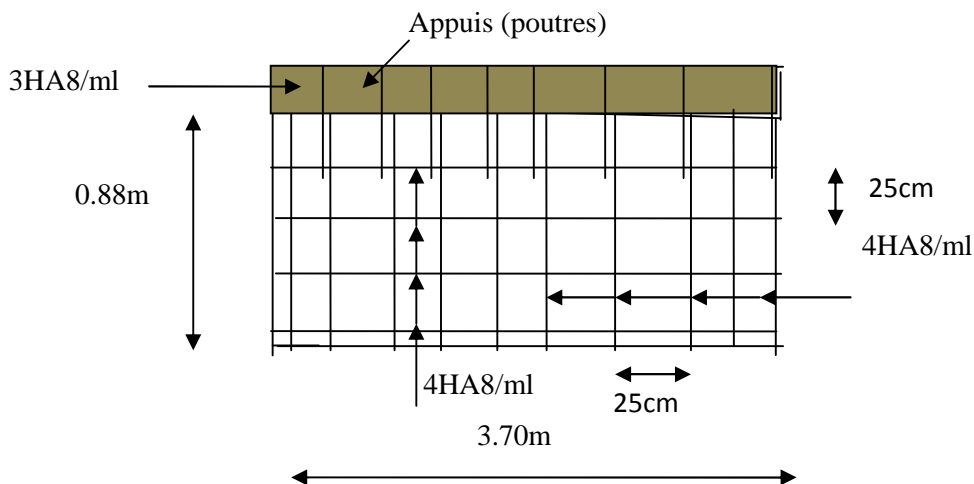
Schéma de ferrailage des dalles sur un seul appui.
